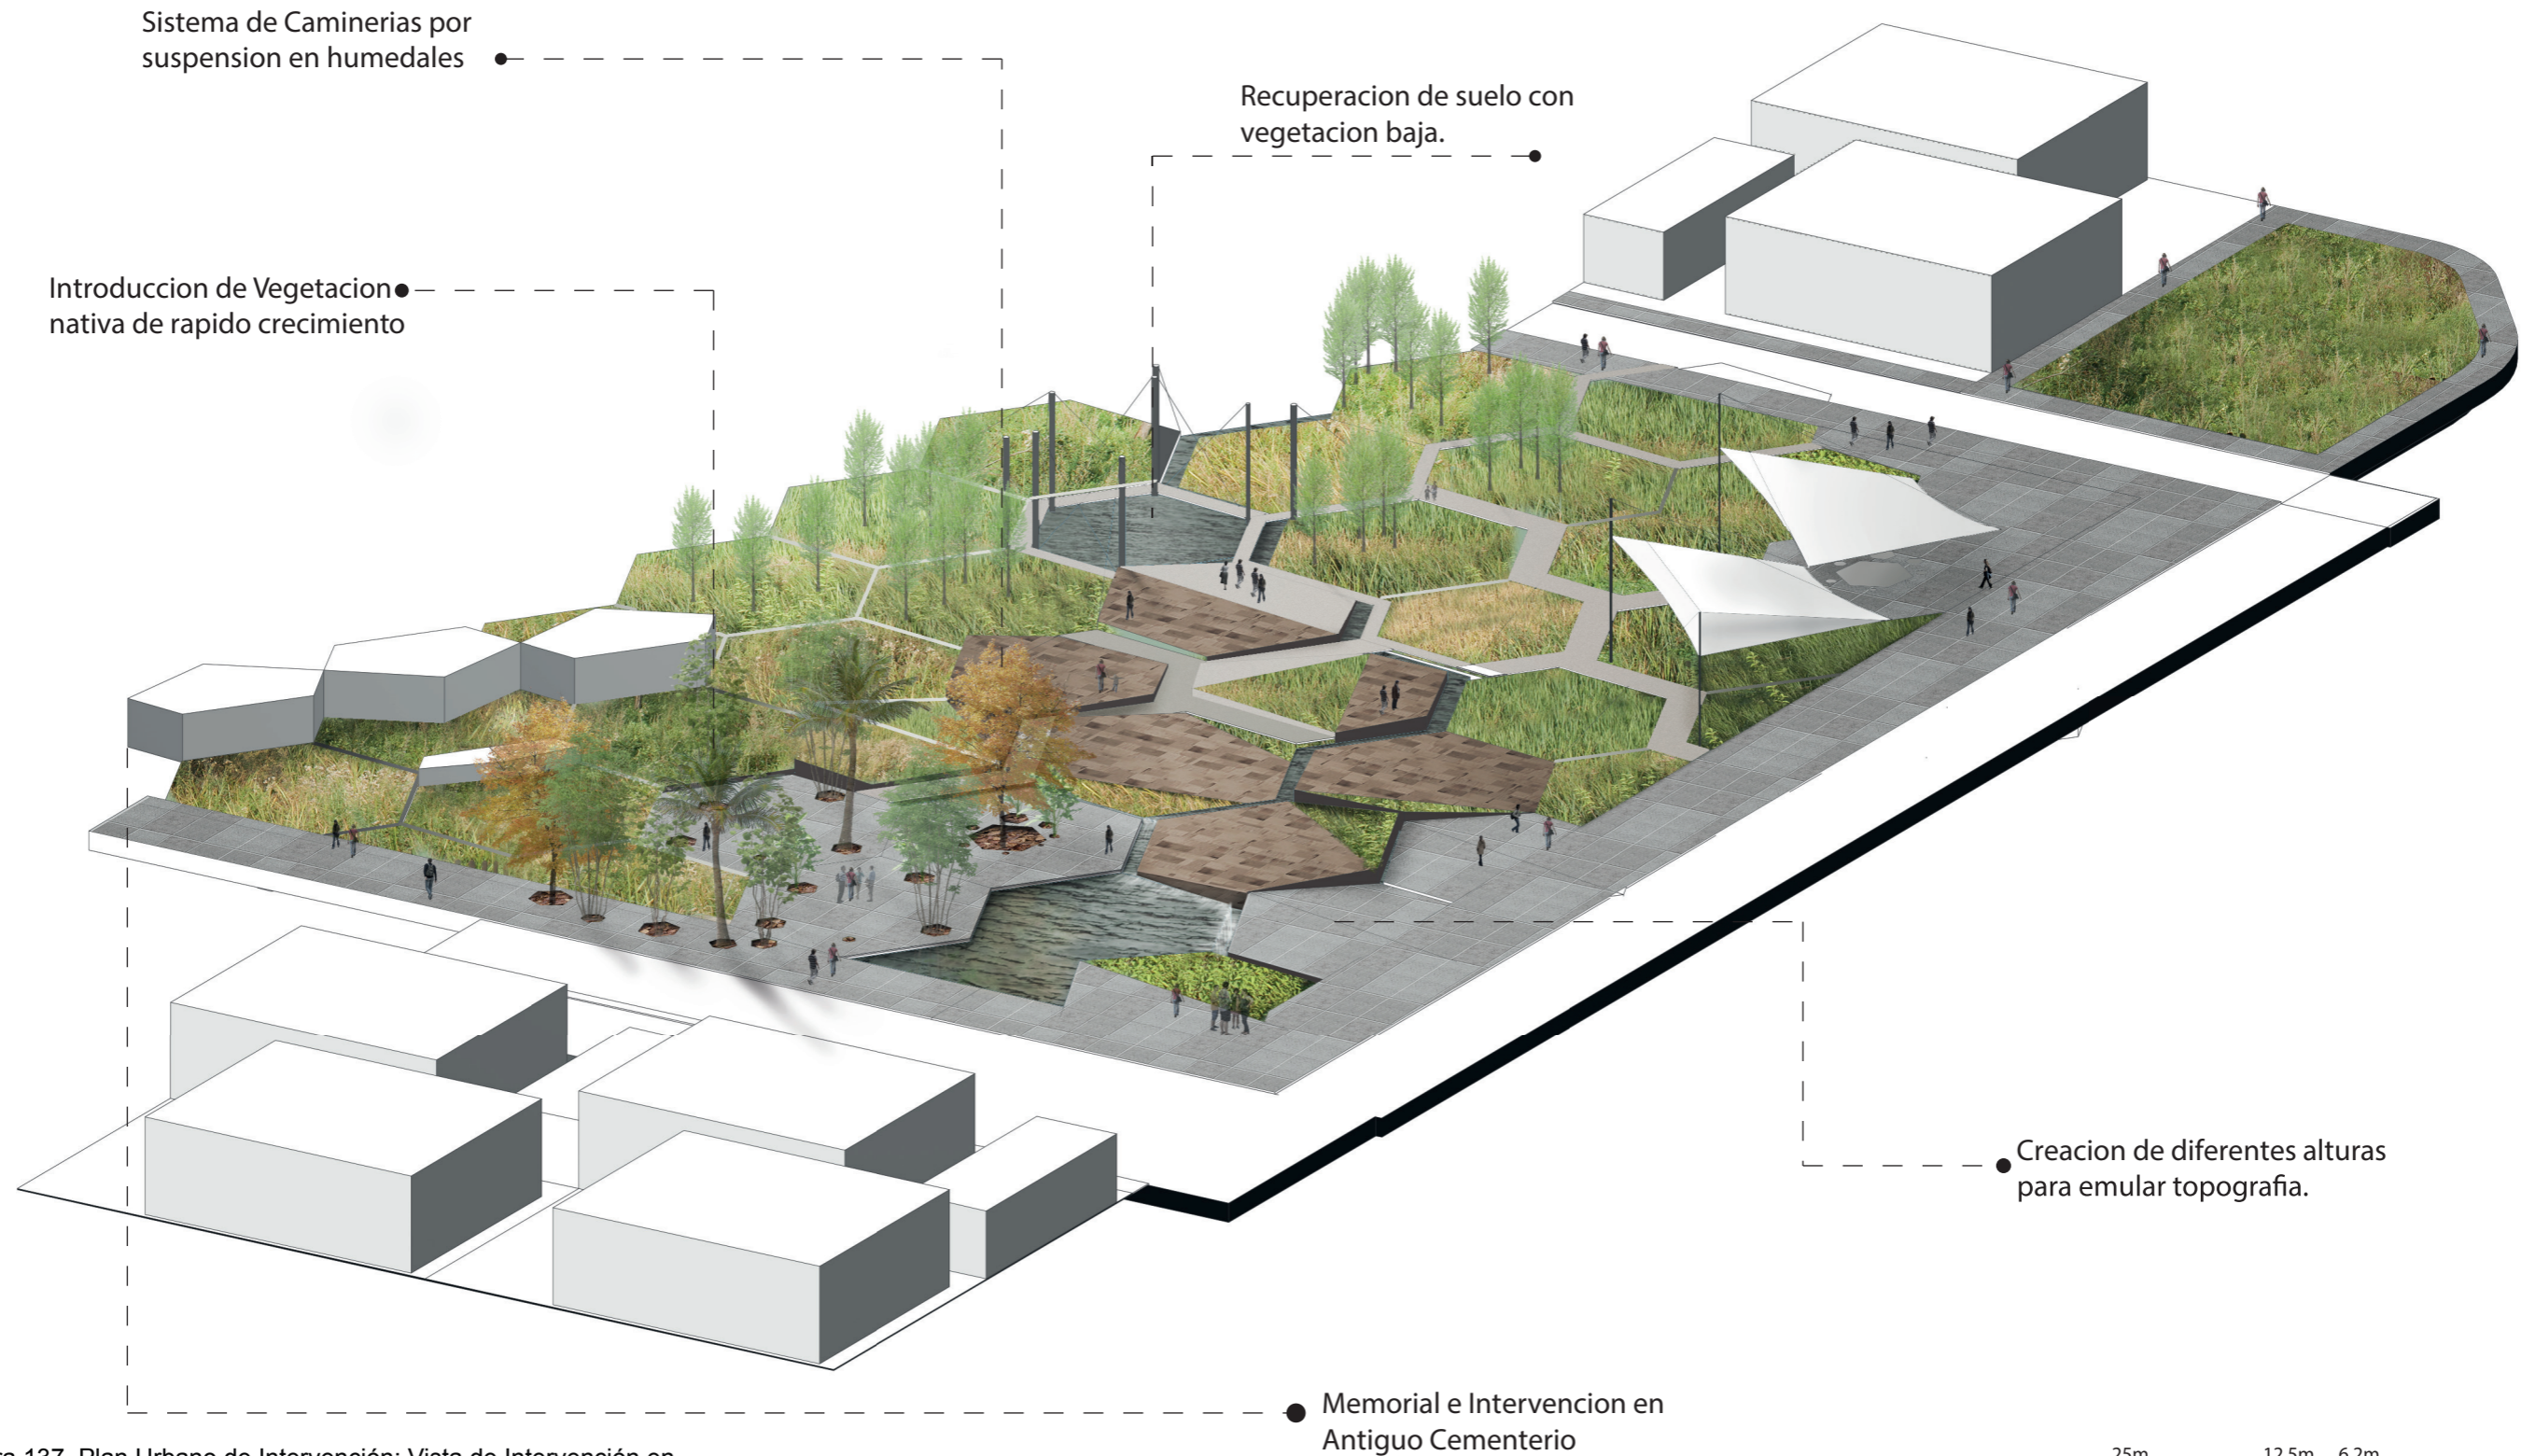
Plan Urbano de Intervención: Vista de Intervención en sección
